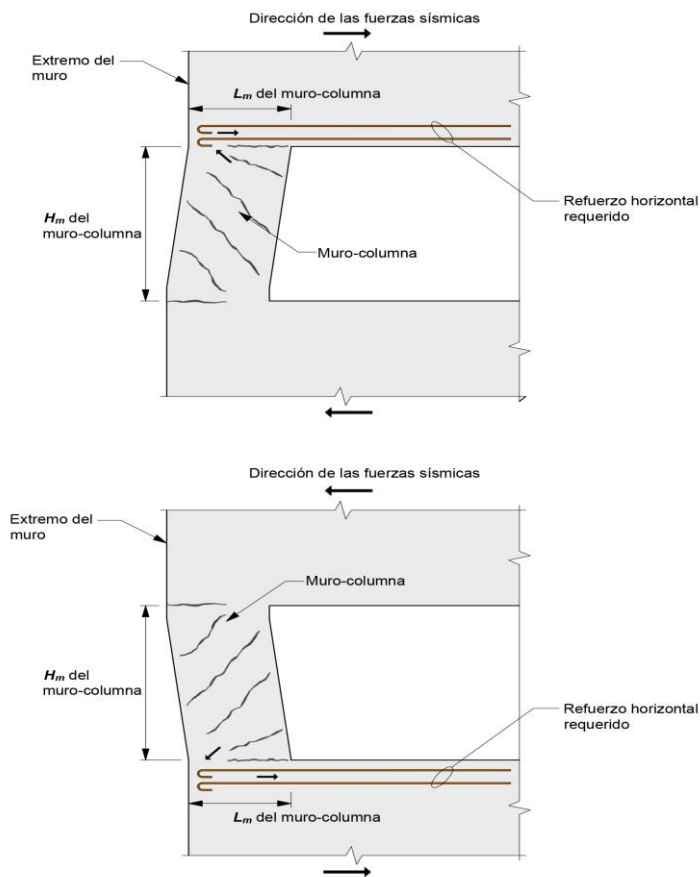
Refuerzo horizontal requerido en segmentos de muro arriba y debajo de un muro-columna en el extremo de un muro (adaptada de ACI CODE-318-19)
